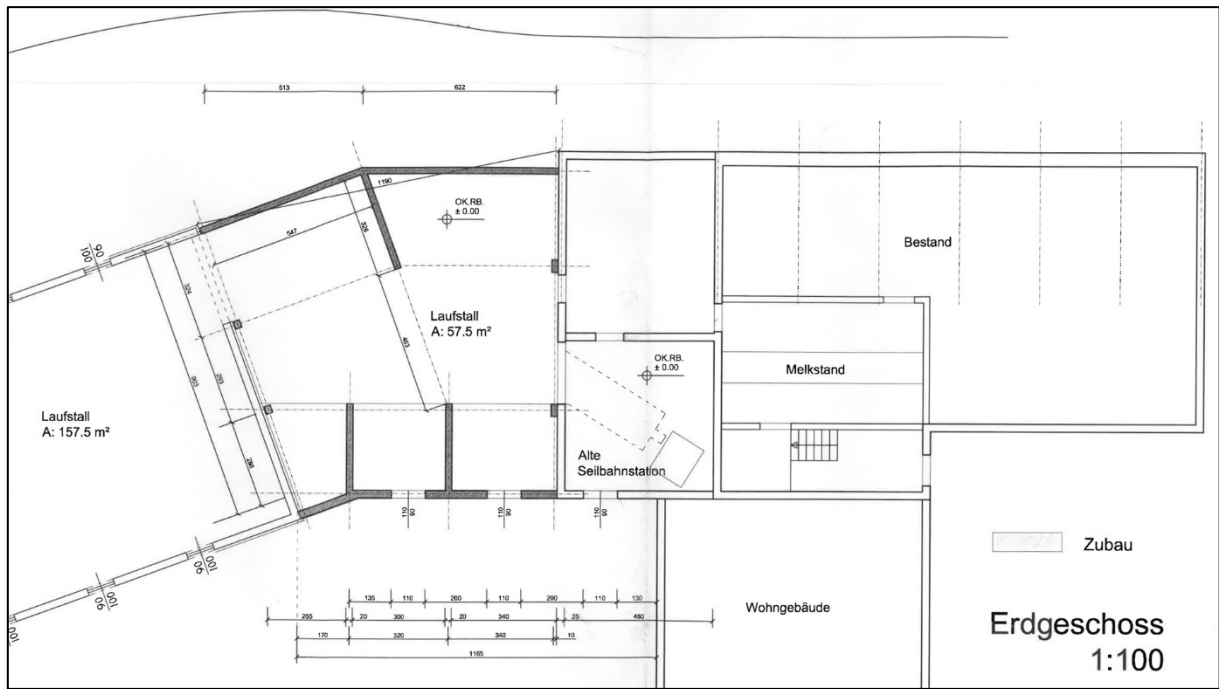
Einreichplan 2003; Grundriss des Erdgeschoßes mit dem alten Standort der Seilbahnstation
